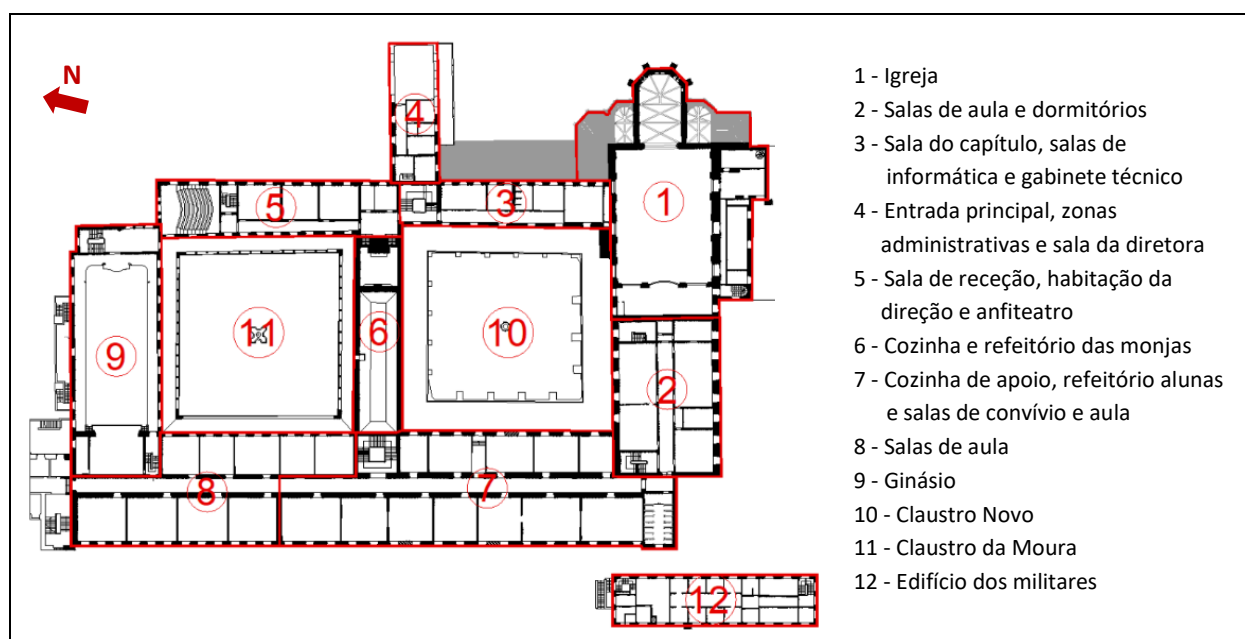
Identificação em planta dos diferentes corpos do Mosteiro de Odivelas (planta do piso 1)
